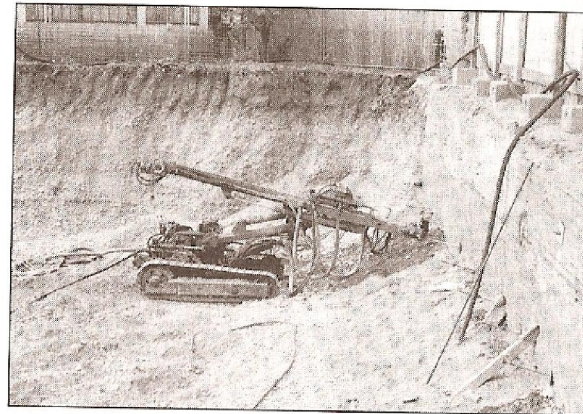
• Paroi clouée – Mise en place des barres d'ancrage.
